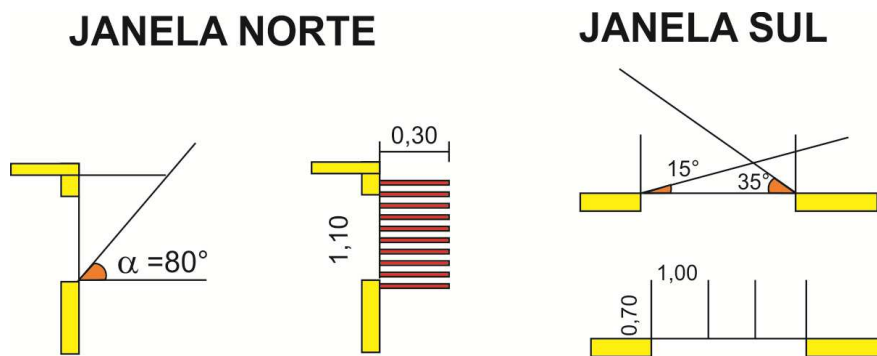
Cálculo de brises para fachadas norte e sul
